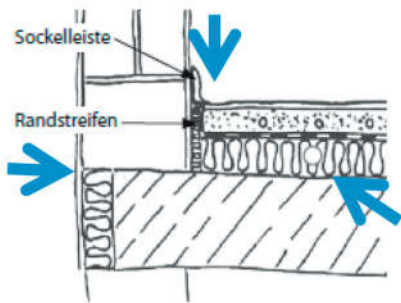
und 5: Dach- und Fußbodenkonstruktionen sind sehr häufig von Schimmelschäden betroffen, ohne dass dies augenscheinlich erkennbar ist (aus 13)
